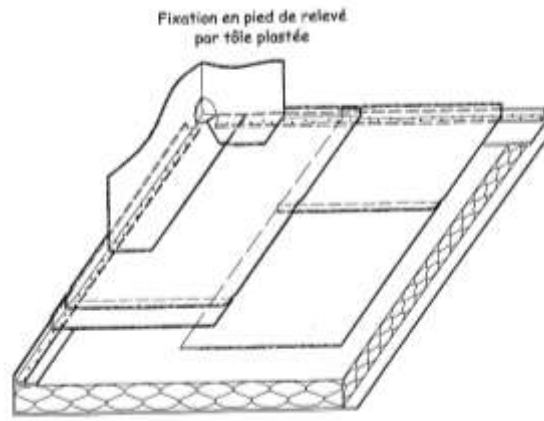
Tôle colaminée RENOLIT ALKORPLAN 81170/81171
